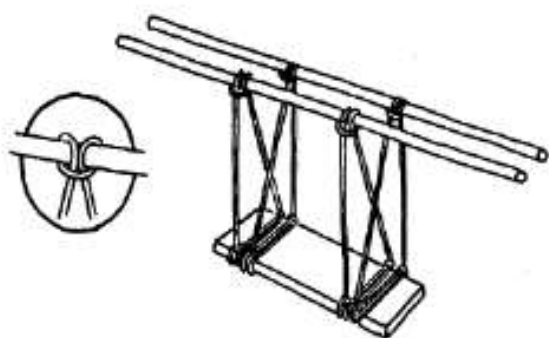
Utilizando o andaime para fazer uma cadeirinha.
